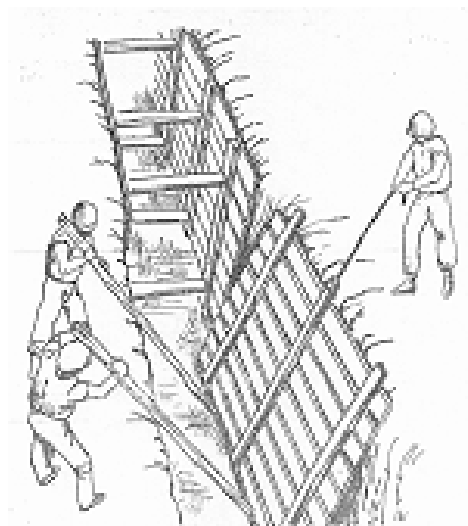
Colocación de ademes para entibar las excavaciones.
